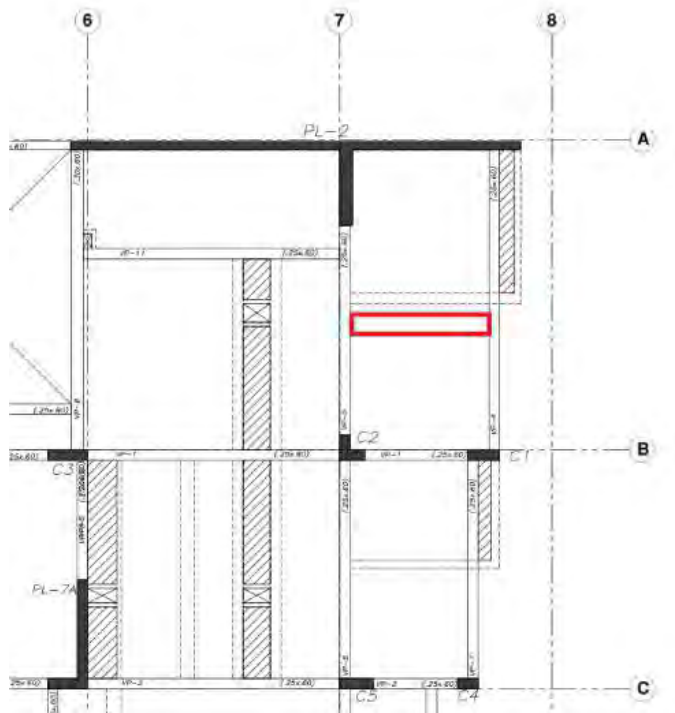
Vigueta típica para ejemplificar metrado de cargas
